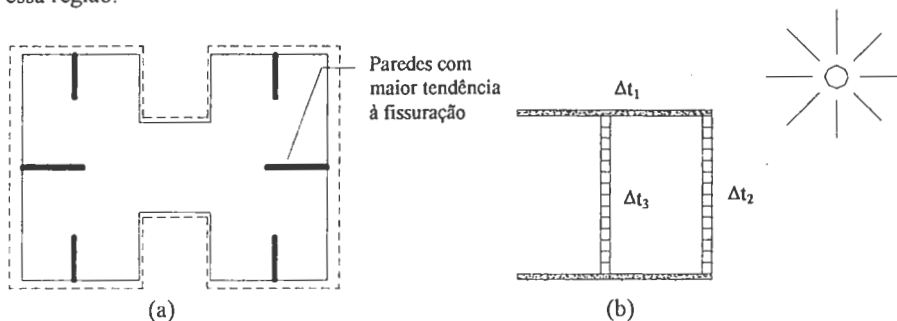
Deslocamentos das lajes e paredes com maior tendência à fissuração
